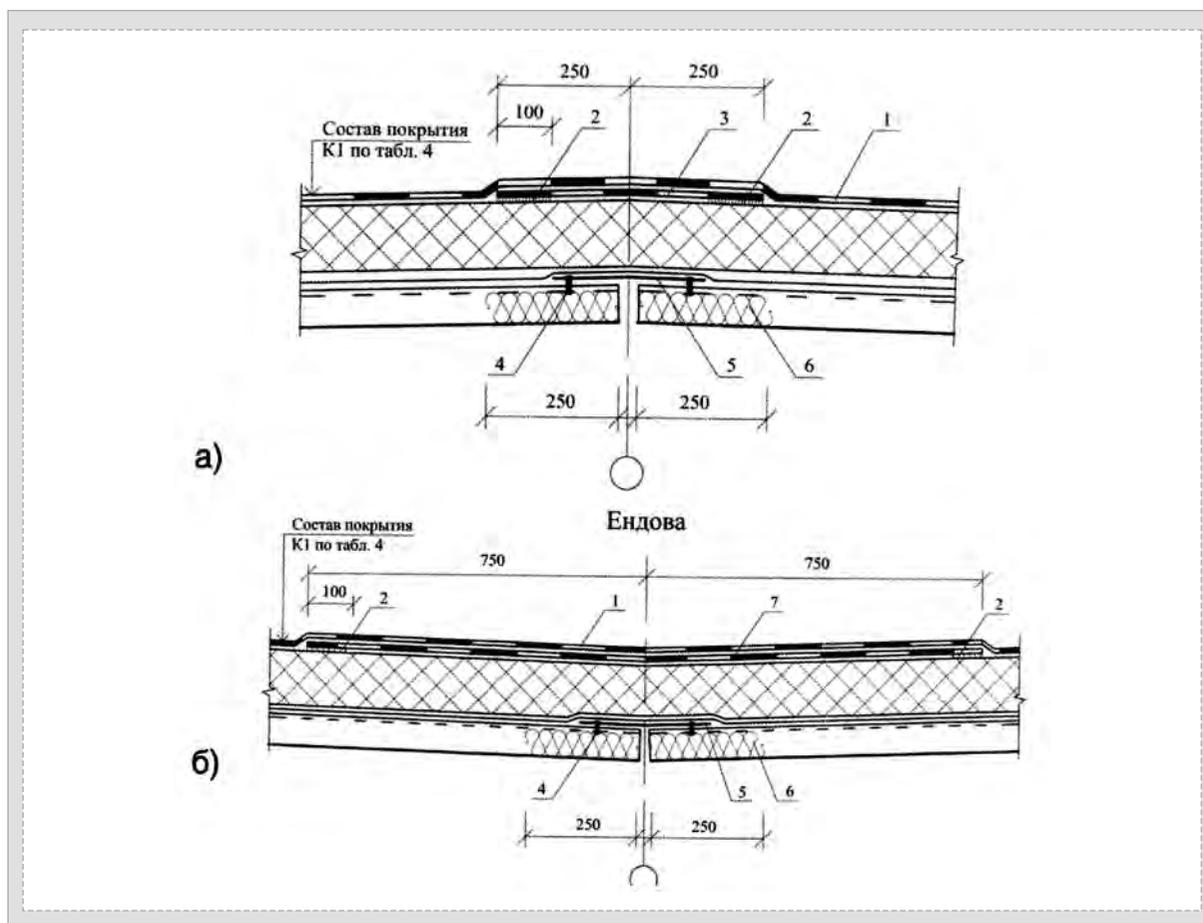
Ендова кровли а) традиционного; б) инверсионного покрытия
